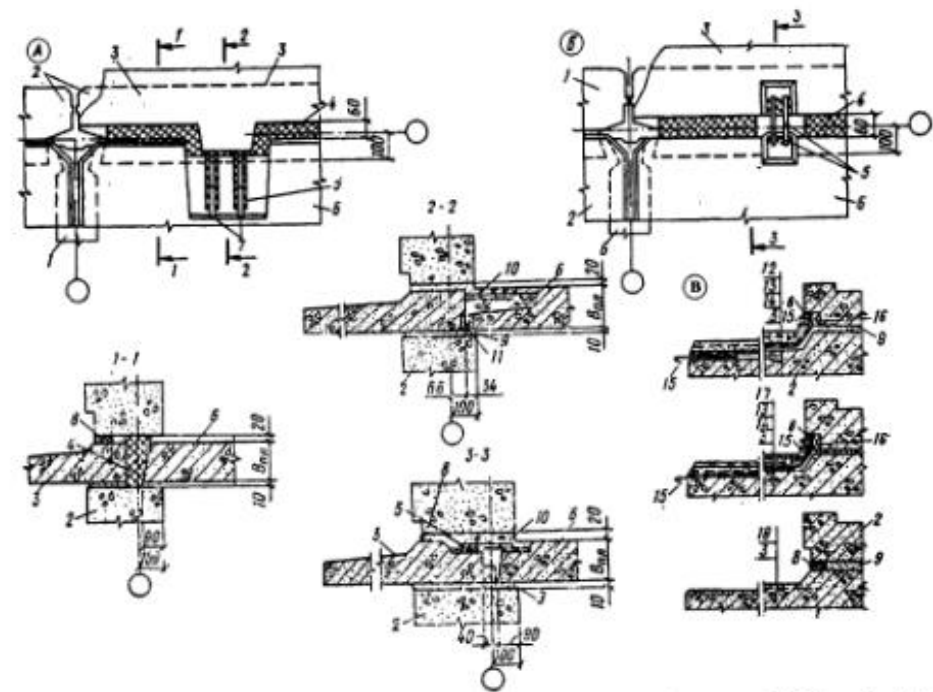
Деталь крепления балконной плиты в панельных стенах: А - толщиной 300 мм; Б - 350-400 мм; В - детали устройства перекрытий балконных плит; 1 - панель внутренней стены; 2 - панель наружной стены; 3 - балконная плита; 4 - утепляющий вкладыш; 5 - стальные связи; 6 - плита перекрытия; 7 - арматурный выпуск; 8 - герметизация; 9 - цементный раствор; 10 - бетон; 11 - упорный стержень, приваренный к балконной плите до монтажа; 12 - цементный пол толщиной 30 мм; 13 - металлическая сетка; 14 - гидроизоляция из двух слоёв рубероида на битумной мастике; 15 - фартук из оцинкованной стали; 16 - деревянная пробка в панели; 17 - керамическая плитка по цементному раствору; 18 - керамическая плитка или цементная железённая поверхность, отделанная в заводских условиях
